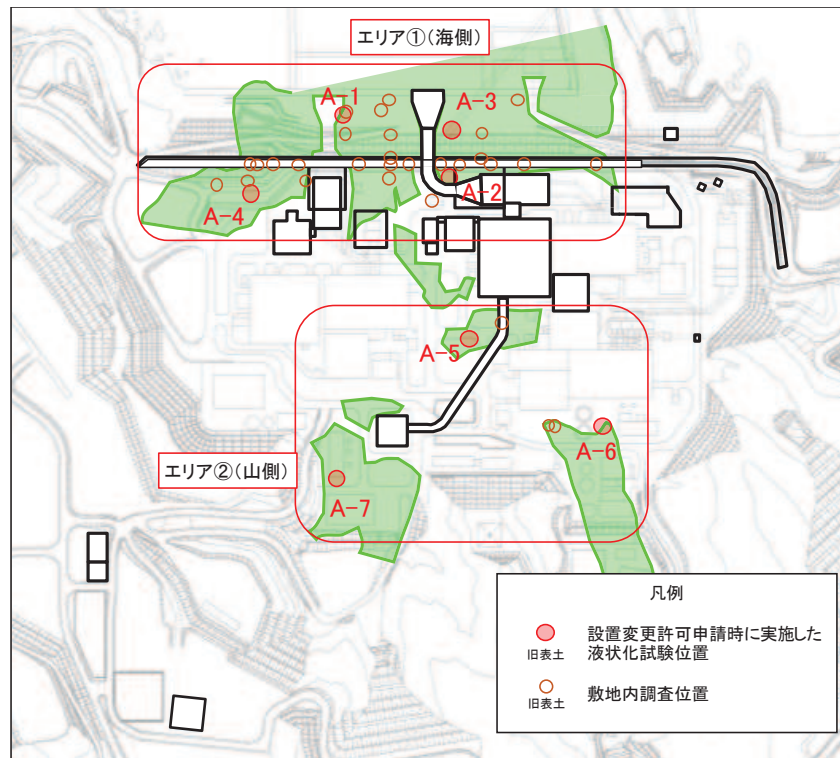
旧表土の液状化強度試験位置及び敷地内調査位置の平面図
